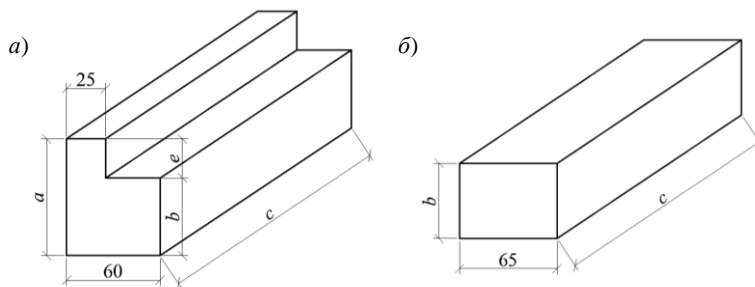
Железобетонные насадки на стеновые блоки:
